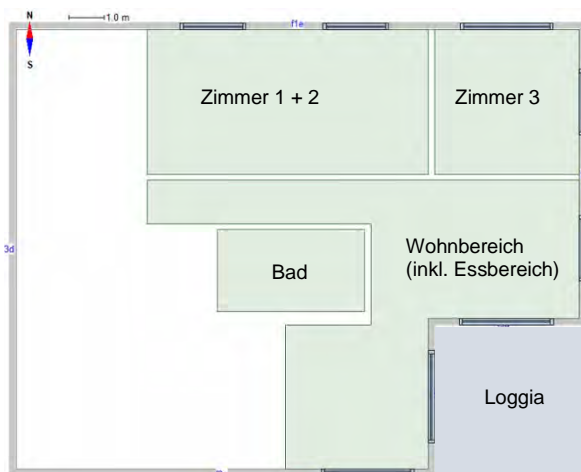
Grundriss des aufgebauten Wohngeschossmodells der 3-Fassaden-Wohnung mit Zonenaufteilung.
